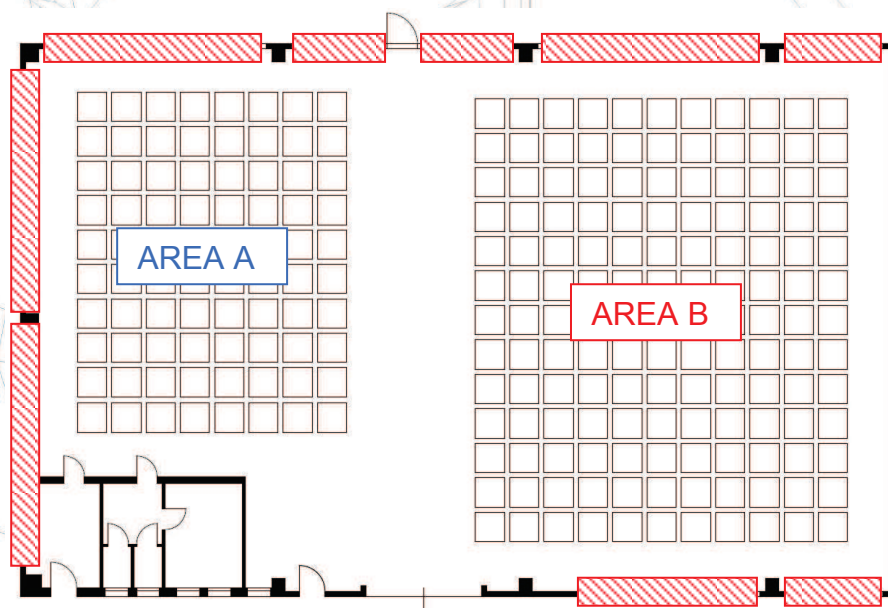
Planimetria esemplificativa della disposizione delle finestre perimetrali che fungono da sistema di smaltimento fumi e calore.
